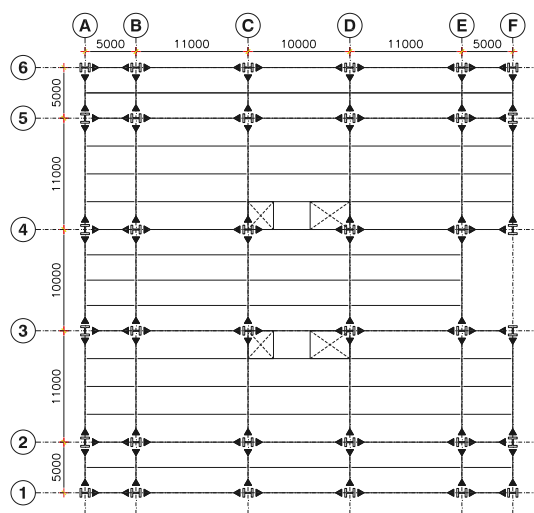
Planta estructural de Edificio#4. Fuente: [6]
